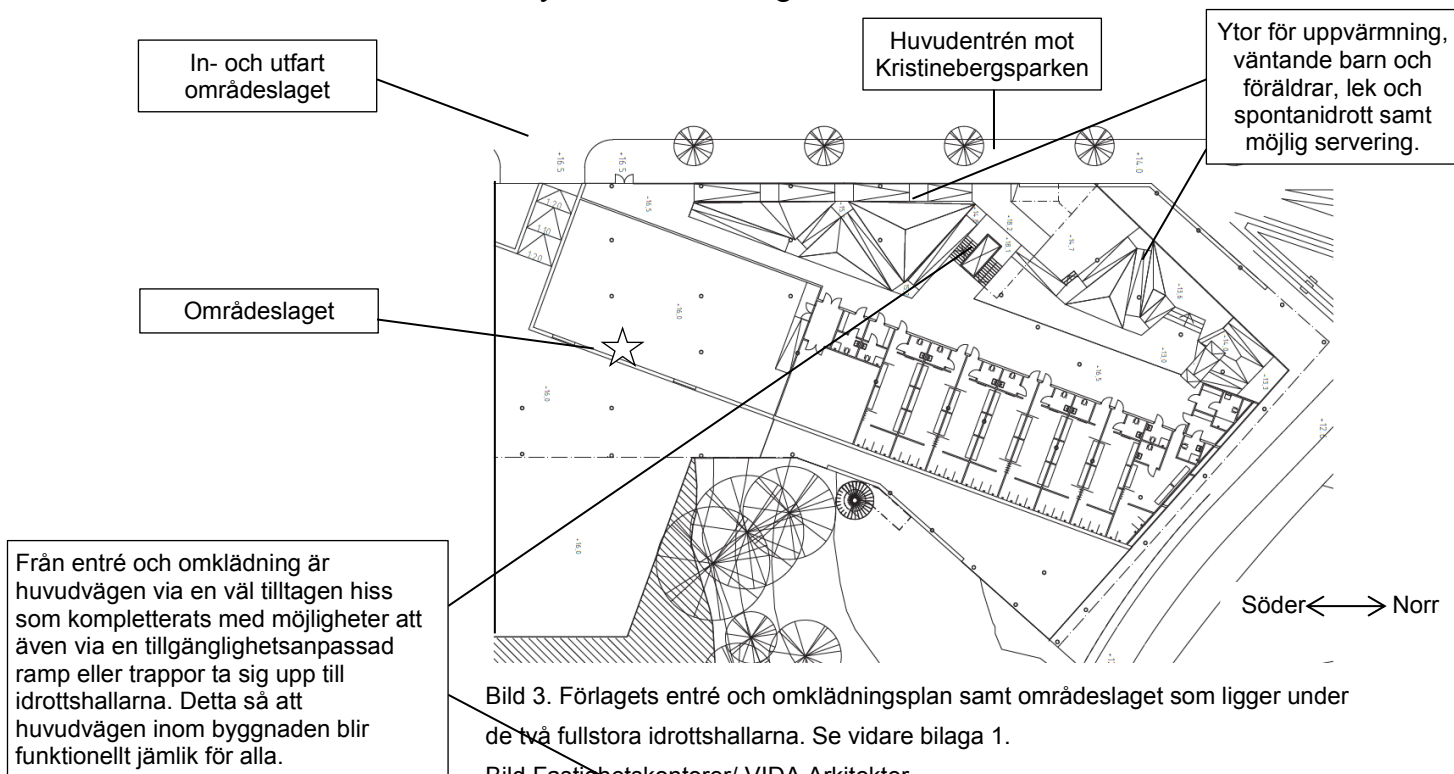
Förslagets entré och omklädningsplan samt områdeslaget som ligger under de två fullstora idrottshallarna. Se vidare bilaga 1.
